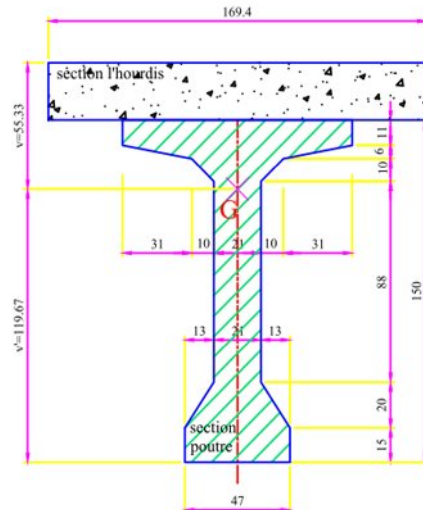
les dimensions de la section de la poutre+l'hourdis à mi-travée
